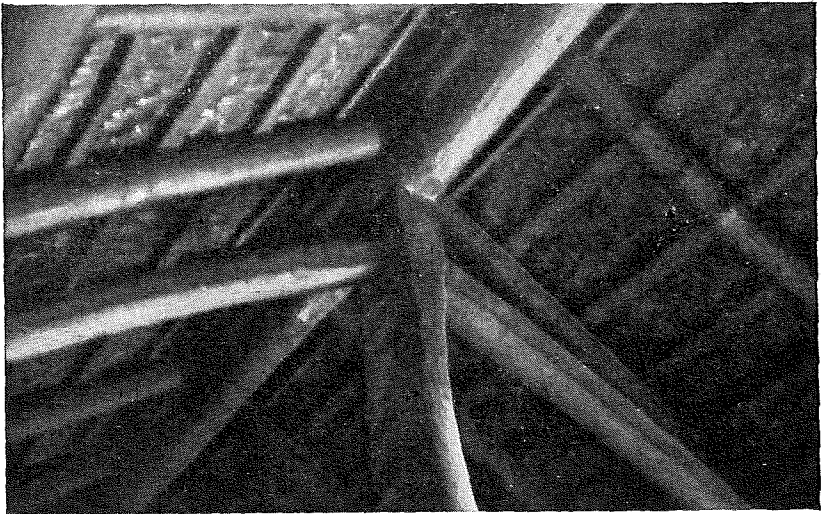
Haus in Notre Dame-de-Monts: Dachgerüst mit Kielsbogensparren und geflochtener Unterlage der Strohddeckung.
